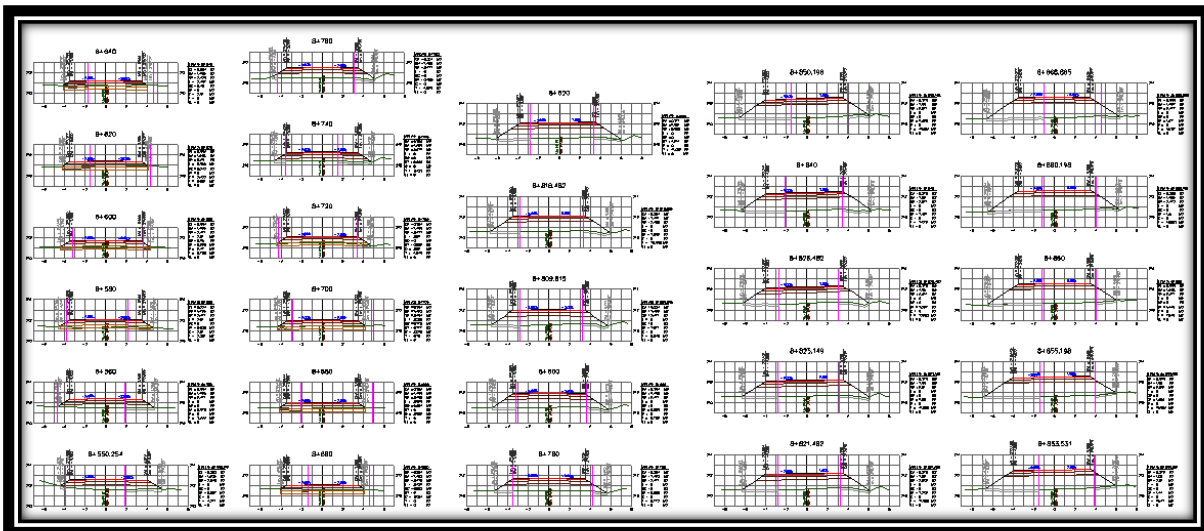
Secciones de construcción del km 8+550.254 al km 8+866.865.
